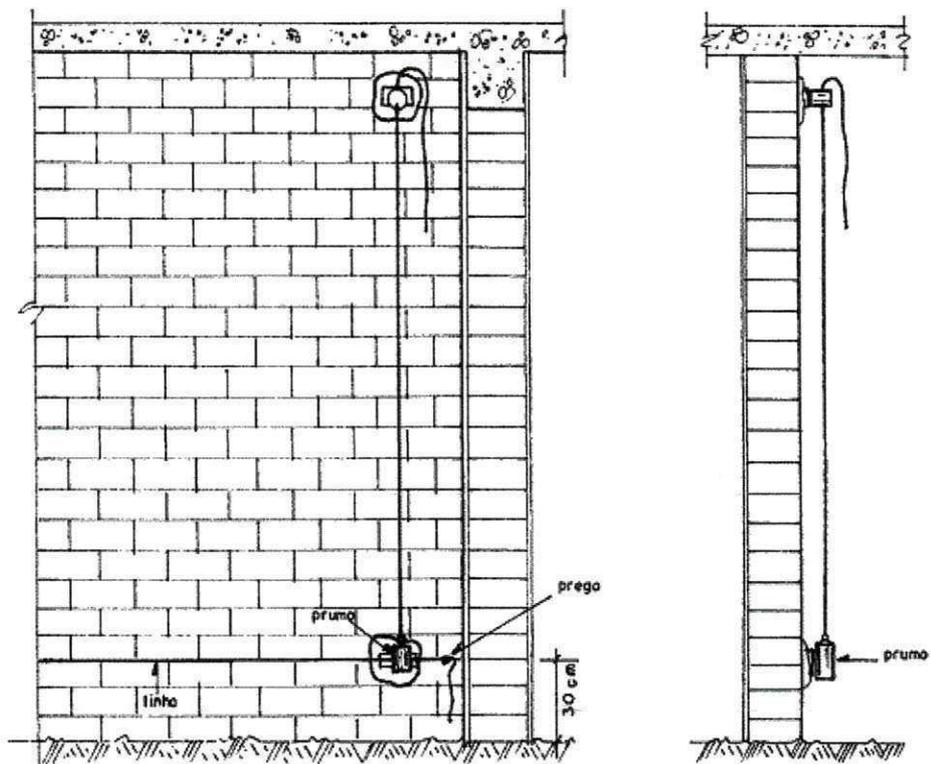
Colocação de Talisca Inferior e Vista Transversal.
